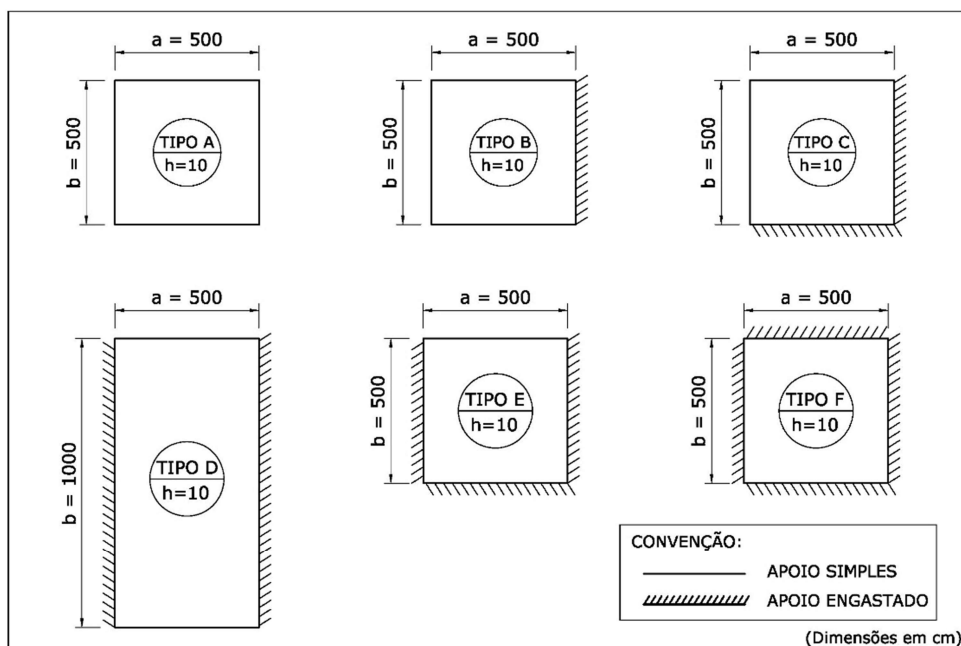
Geometria das lajes isoladas (Fonte: Autor)
